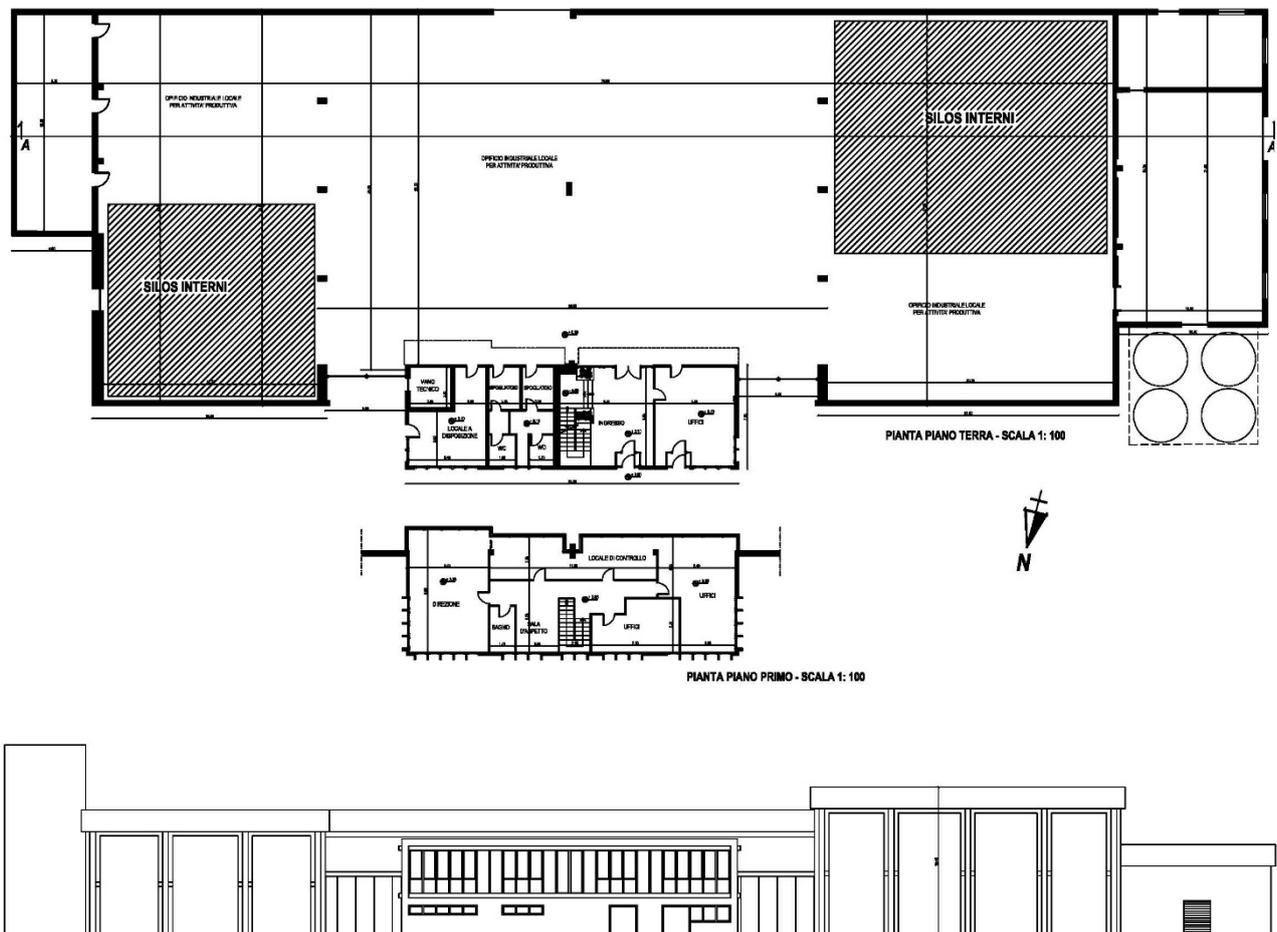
PLANIMETRIA DELL'EDIFICIO ESISTENTE E PROSPETTO NORD
